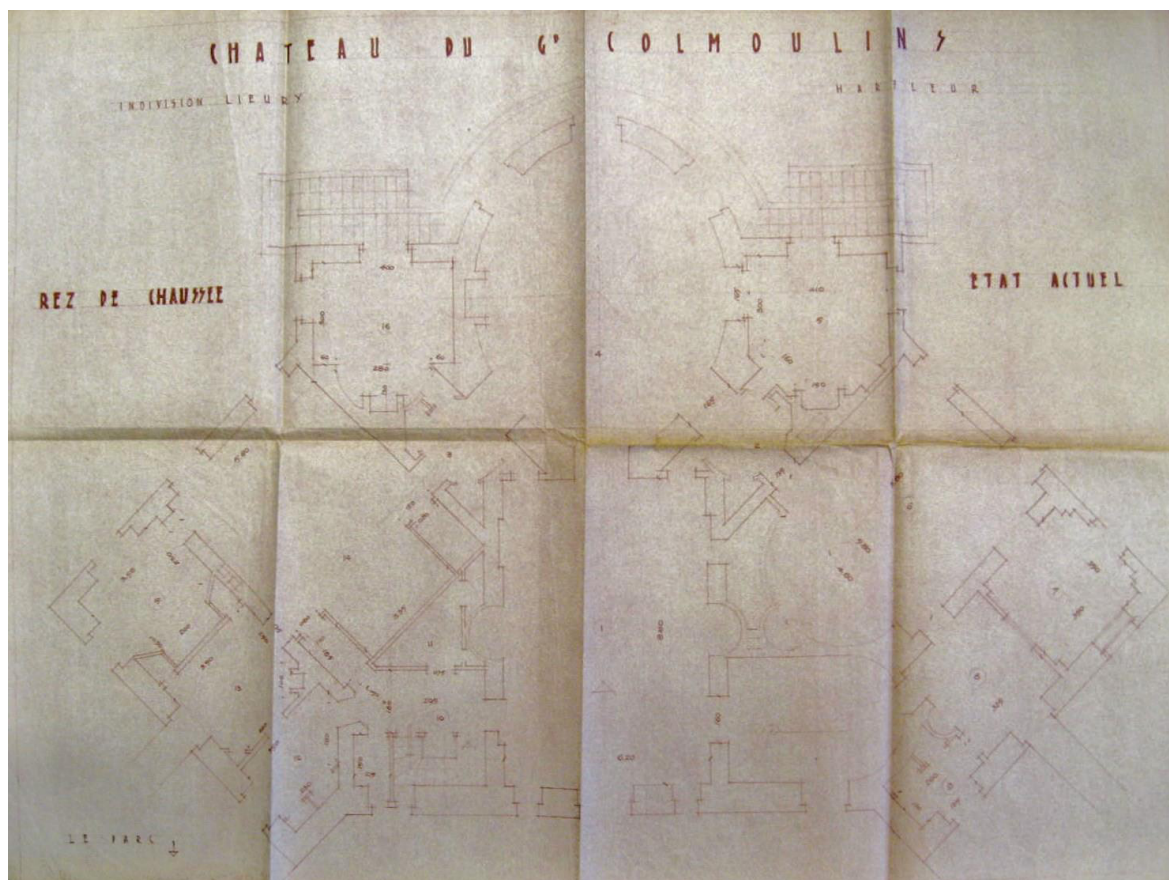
1947 Plan du rez-de-chaussée pour la restauration du château de Colmoulins par l'architecte Loisel. ADSM 238 W 4938.
